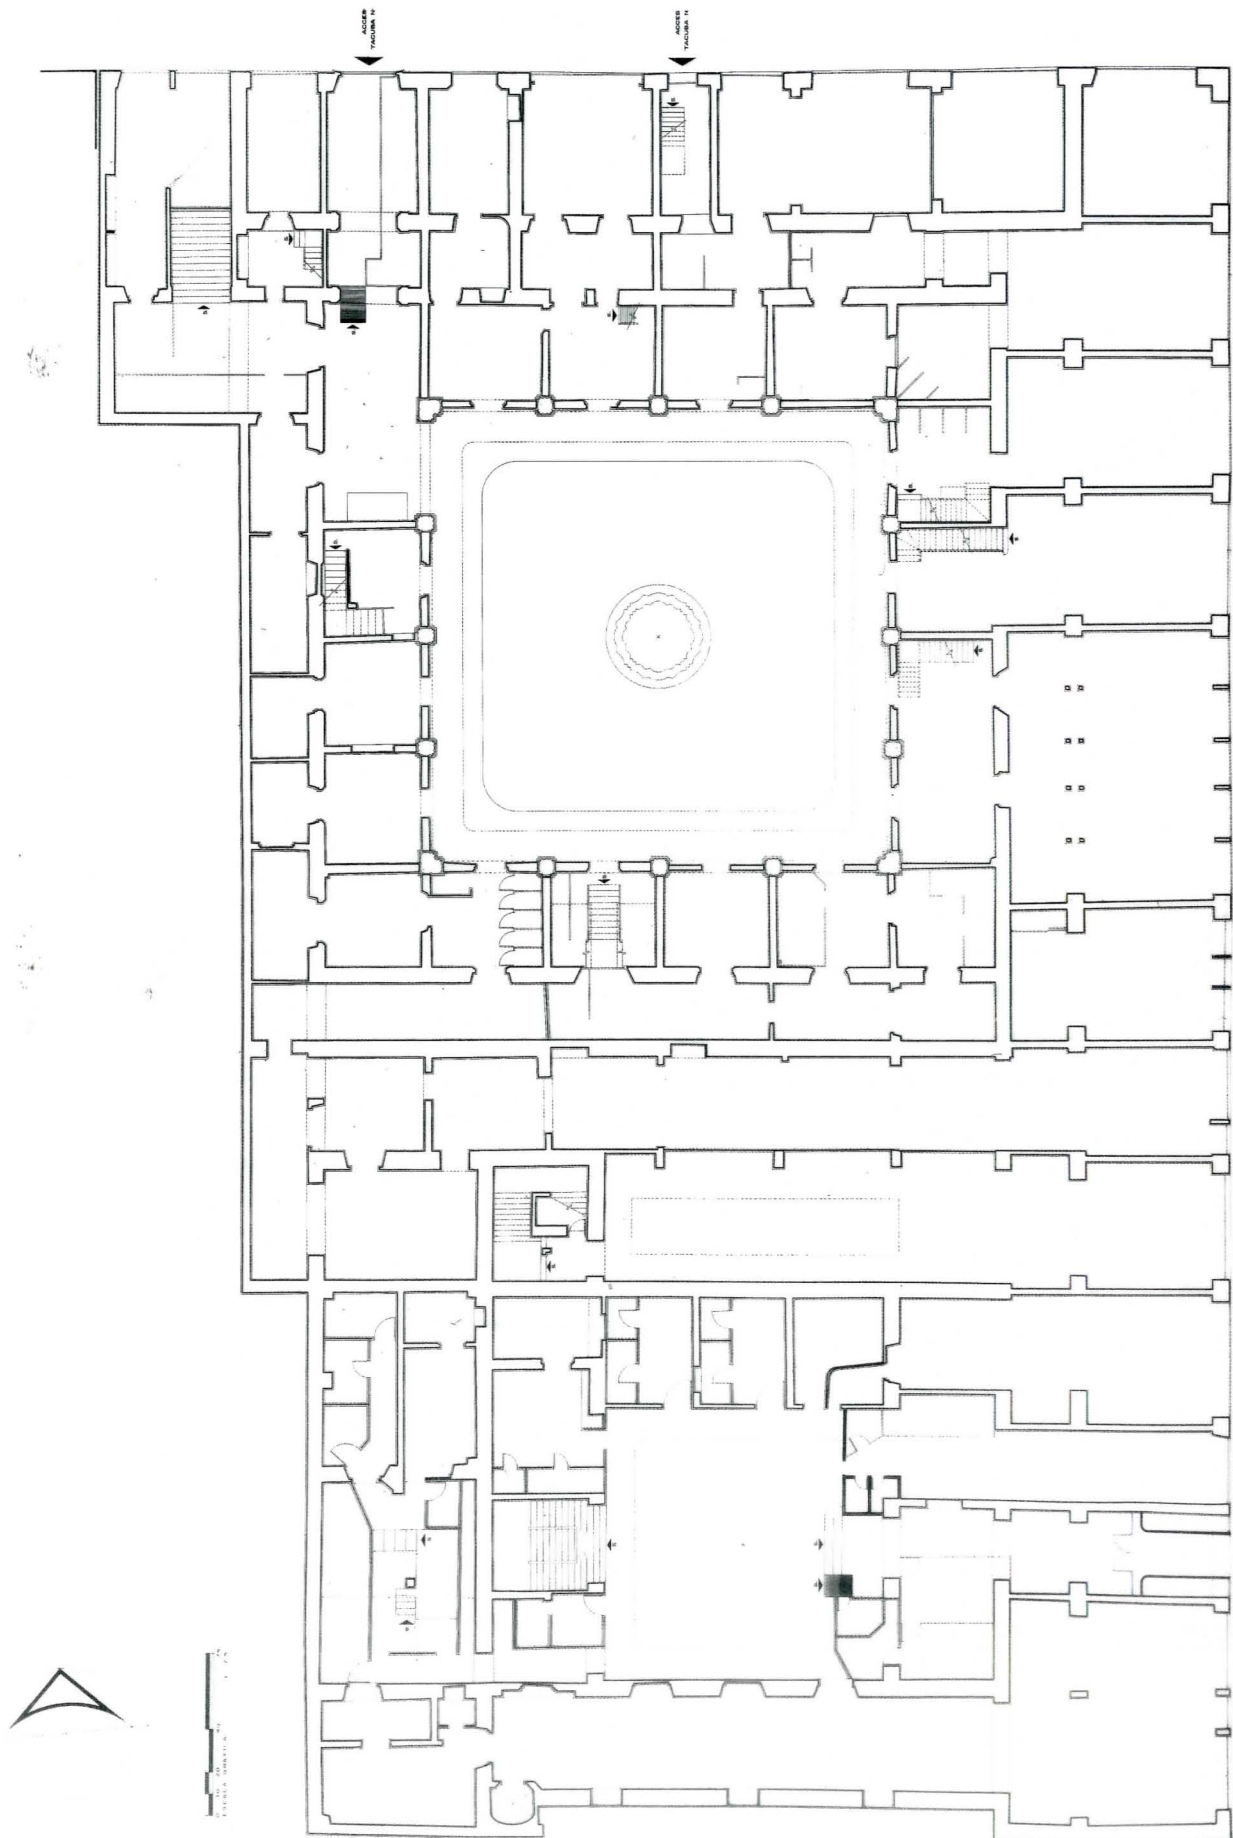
Plano de los departamentos de la vecindad del antiguo convento de Betlemitas antes de la restauración / Planta Baja
